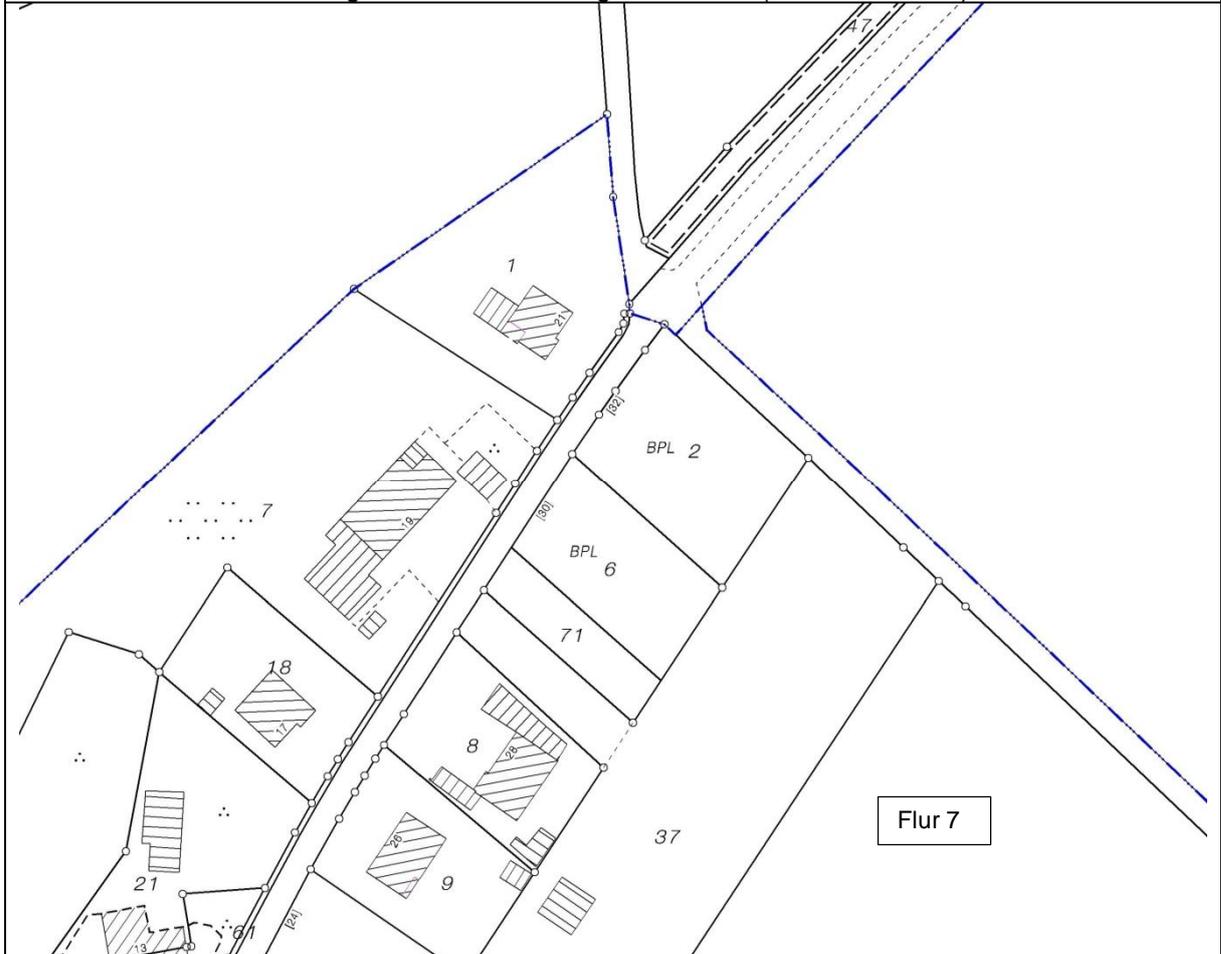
Darstellung der bisher gültigen Ergänzungssatzung (unmaßstäblich)
